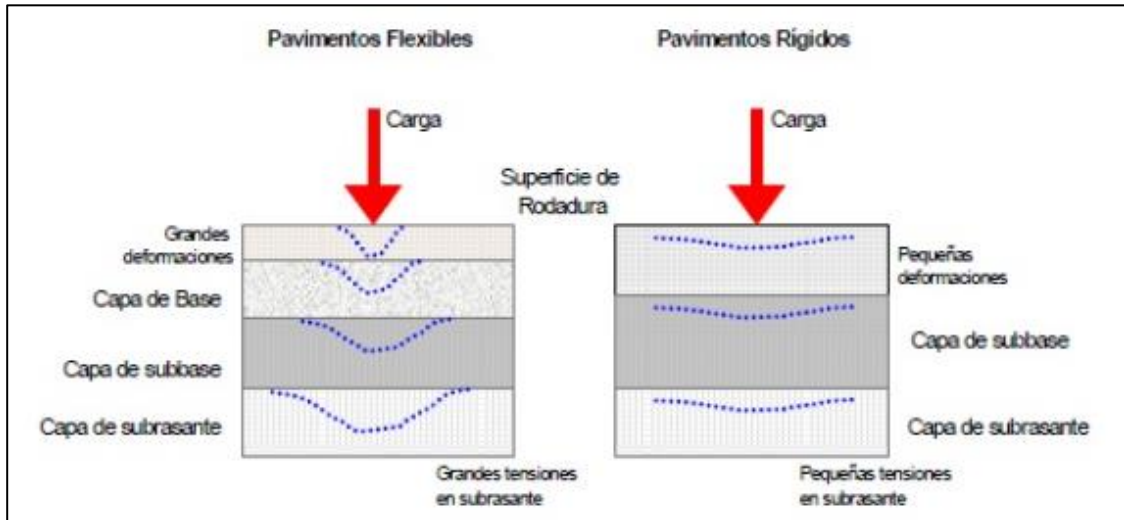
Capacidad de soporte de pavimento flexible y rígido.
